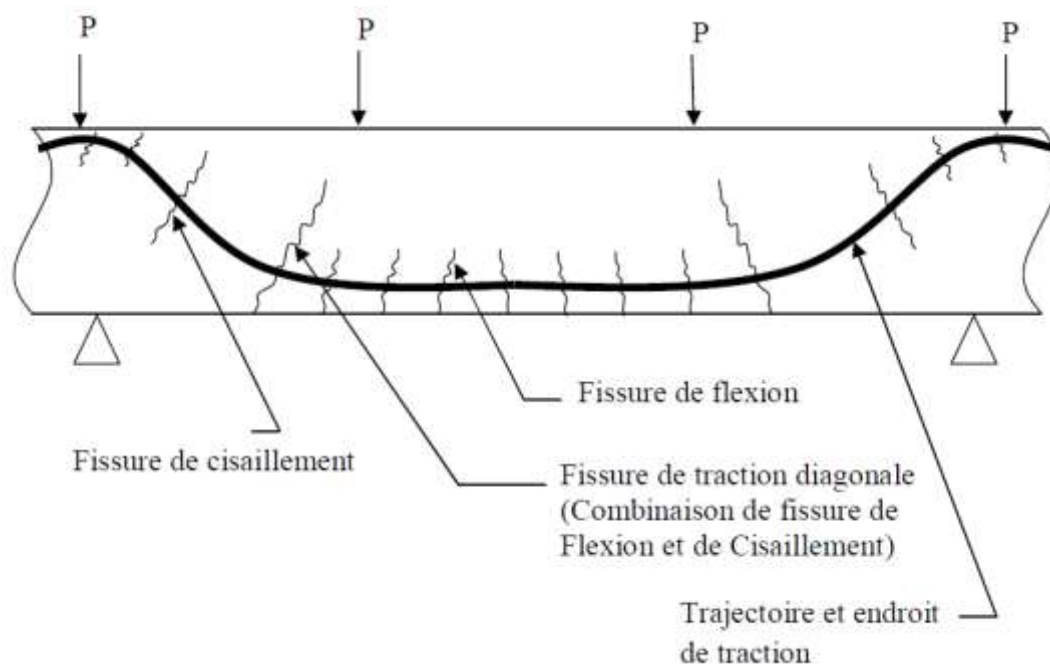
I.1 : Localisation des fissurations dans une poutre [3].
